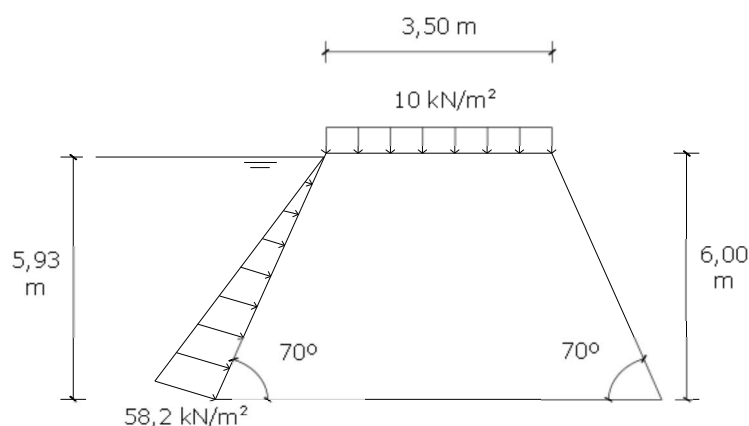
Perfil transversal do muro considerado no dimensionamento
